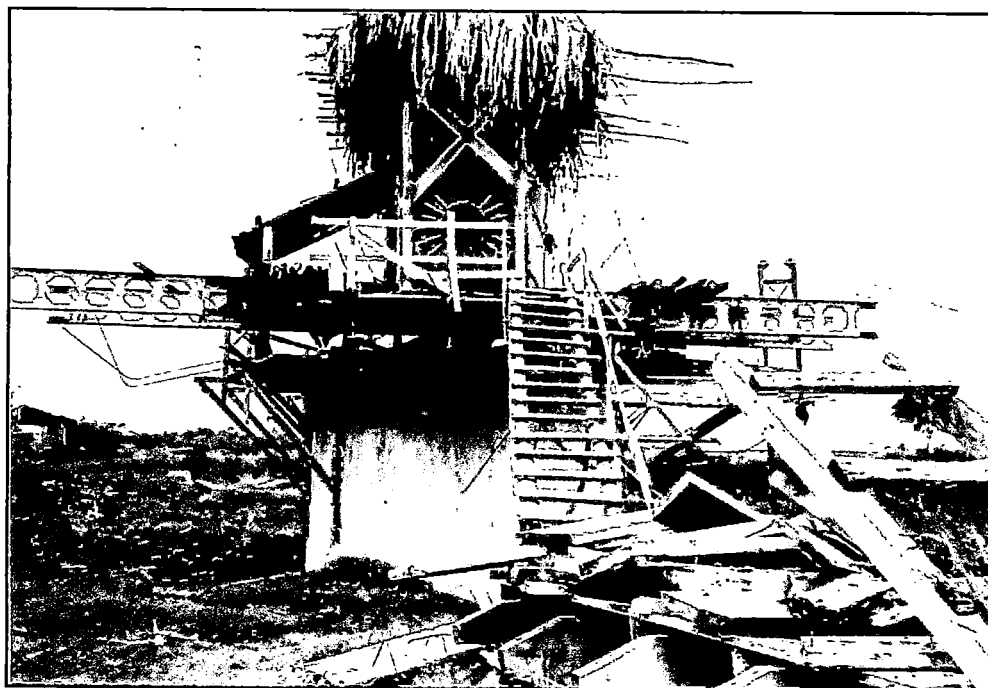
Vista del armado en detalle de la campana neumática y la plataforma de lastrado en estribo de la margen izquierda. Subiendo la escalera se encuentra la entrada al recinto hermético.
